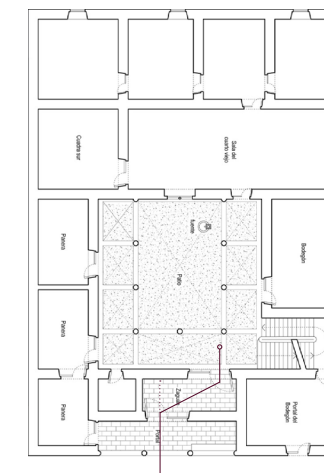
Esquema de planta baja del Palacio de Francisco Ramírez. Zamora, S. XV. Daniel López 2023.
